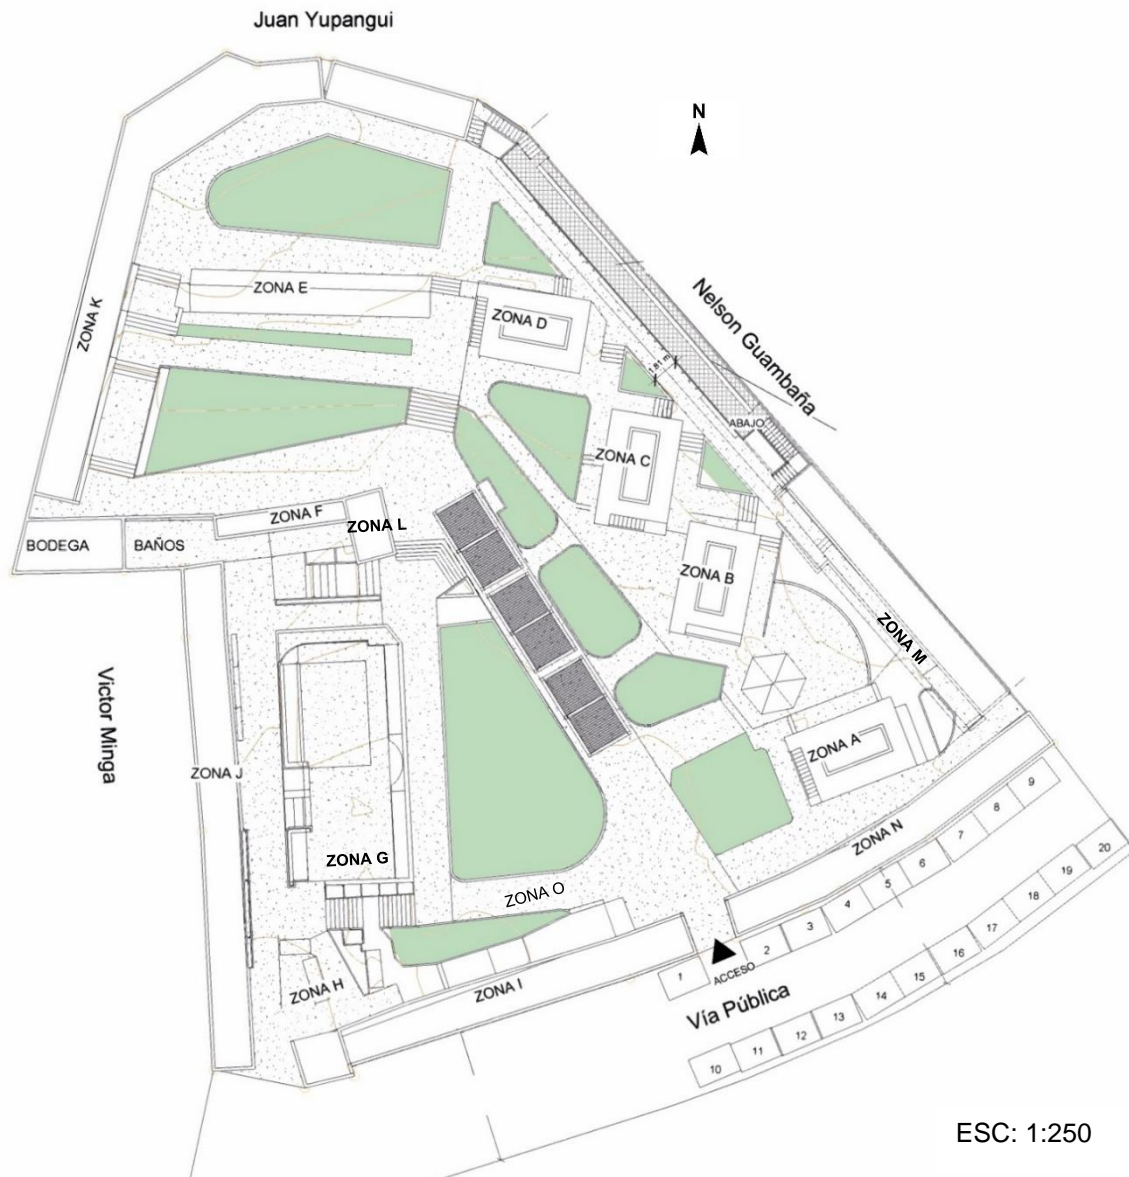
Ubicación del cementerio de parroquial de Baños.
